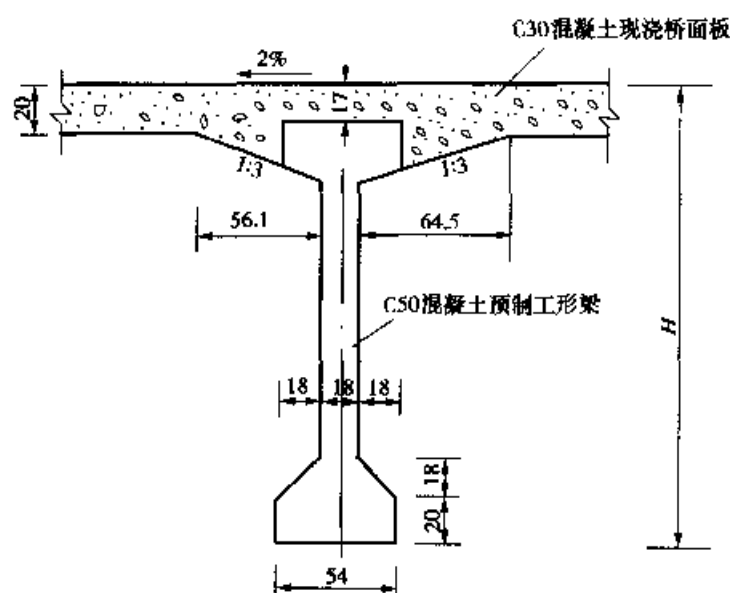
预应力混凝土工形组合梁(尺寸单位:cm)
